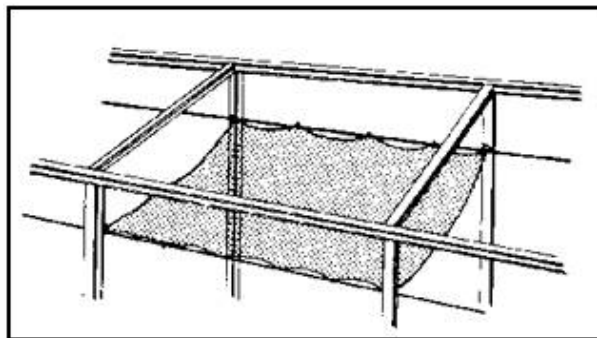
Red horizontal de recogida para la construcción de naves industriales
